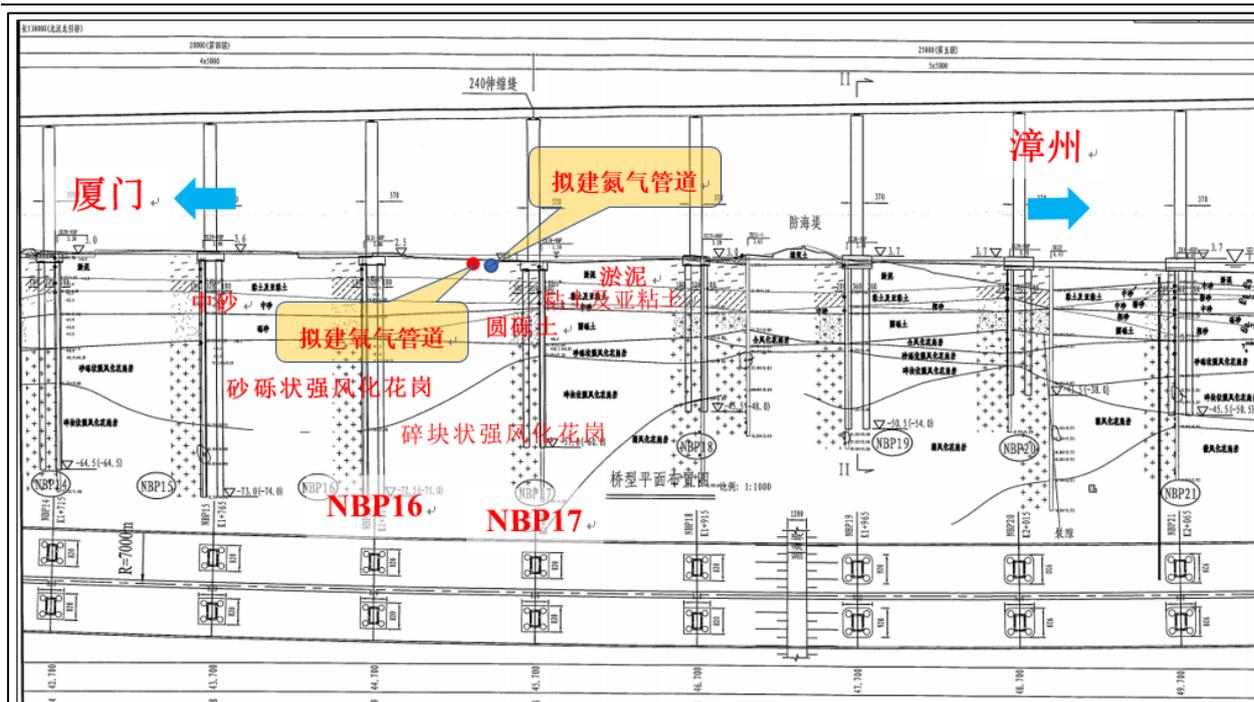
本项目管道下穿厦漳大桥北汉北引桥地质纵断面图（引自施工图）
